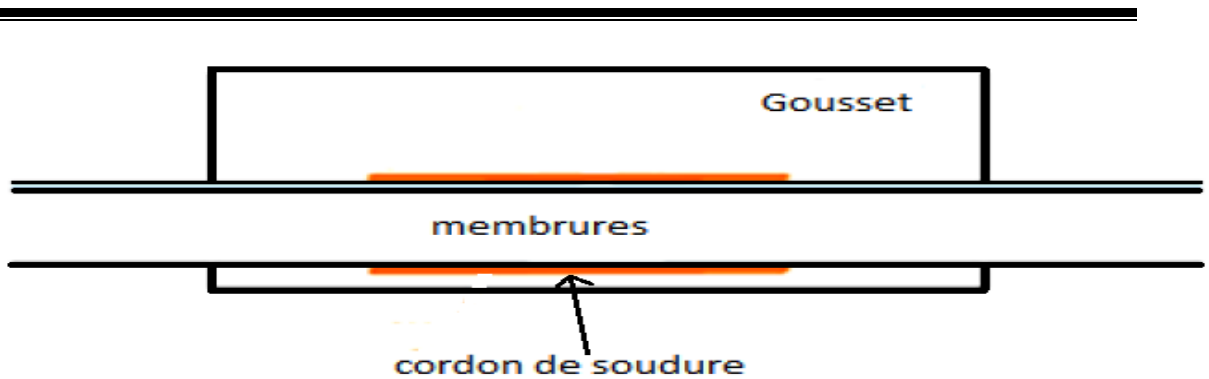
Détail d'assemblage Gousset-membrures de la ferme.
